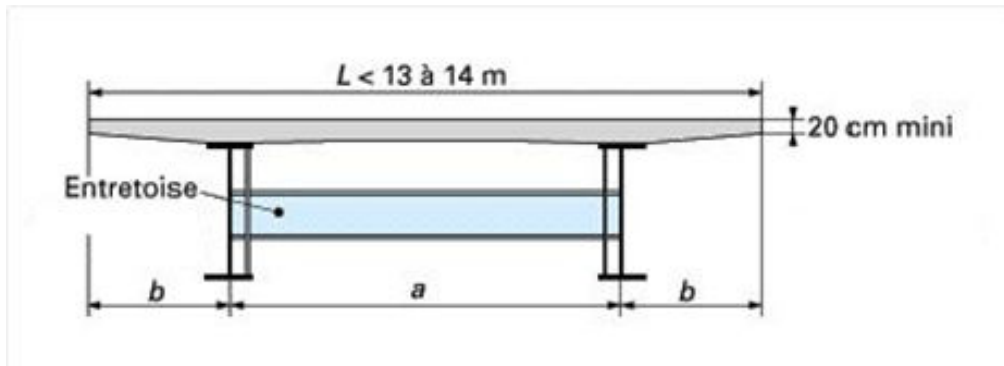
Coupe transversale dans le tablier en bipoutre
